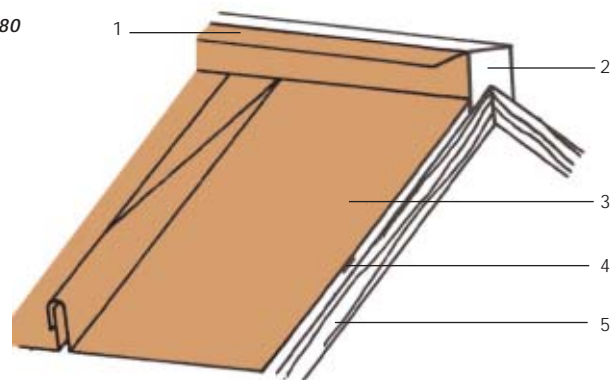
Detalhes da junta elevada da vertente com a junta com o caibro da cumeeira.
